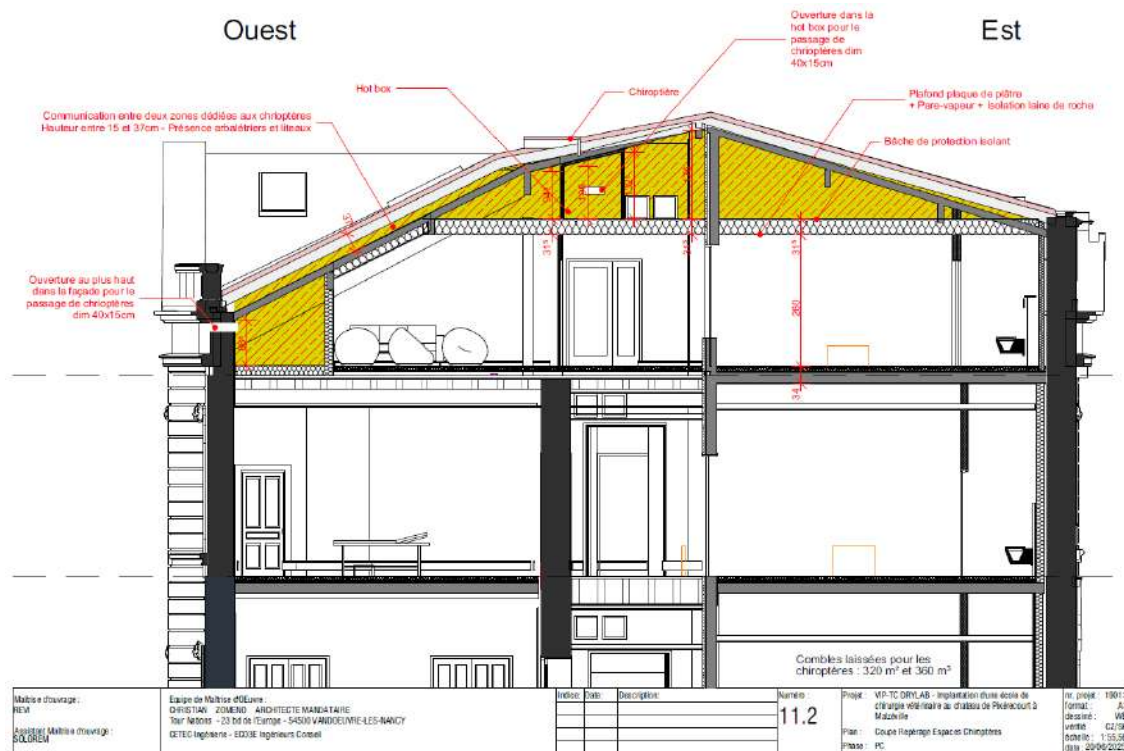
Plan des combles (Atelier Zoménio, 2025)
